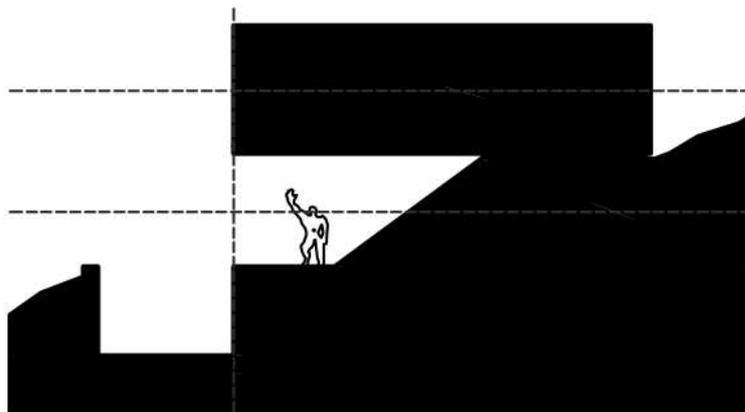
Diagramme de l'auteur, fond de coupe : coupe transversale ouest-est dans la maison horizontale
